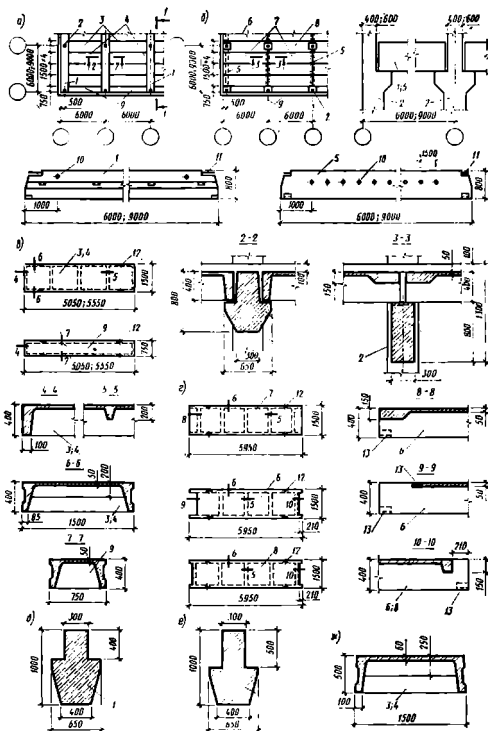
Сборные крупногабаритные перекрытия многосторонних промышленных зданий: а, б — схемы укладки плит: а — плиты, опирающиеся на ригель таврового сечения; б — плиты, опирающиеся на прямоугольный ригель; в, г — сечения ригелей под увеличенную нагрузку на перекрытие; ж — сечение плиты под увеличенную нагрузку на перекрытие; 1 — ригель таврового сечения; 2 — колонна; 3, 6, 8 — плиты-распорки внутренние; 4, 7 — основные рядовые плиты; 5 — ригель прямоугольного сечения; 9 — плиты-распорки наружные; 10 — сквозные отверстия; 11 — выпуск арматуры; 12 — сетки для подъема; 13 — закладные детали
